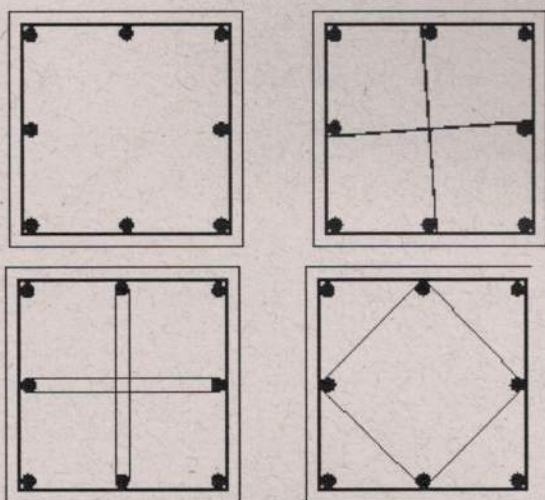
Arranjos de estribos para pilares quadrados (ACI(1992))
